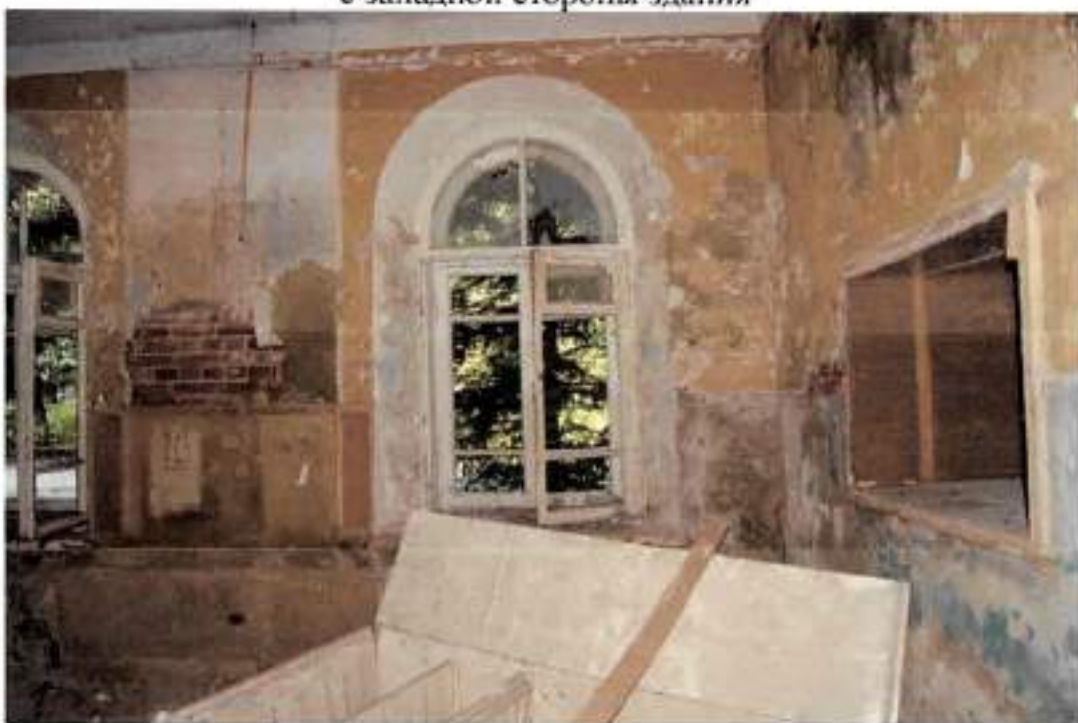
Вид на оконный проем 1-го этажа в помещении с восточной стороны здания
